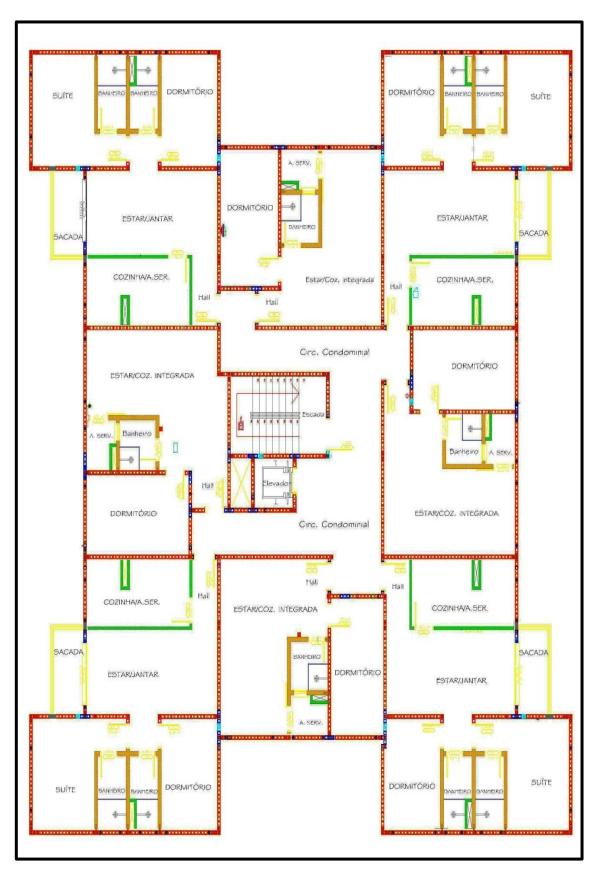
Modulação da edificação. (Fonte: Construtora, 2012)
